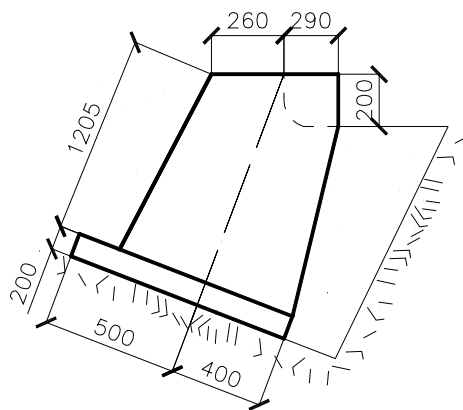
Блочний фунда­мент з похилою підшоною
